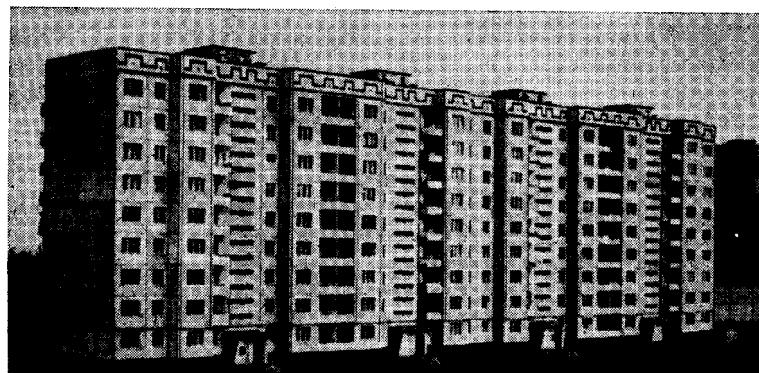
Девятиэтажный жилой дом с наружными стенами из керамзитоперлитобетона
